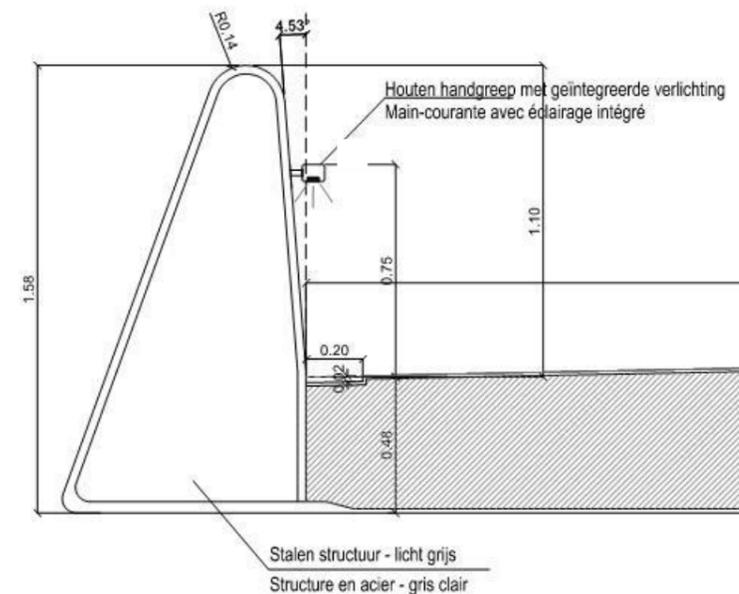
Architecturale vormgeving brugstructuur en verlichting geïntegreerd in de handgreep
